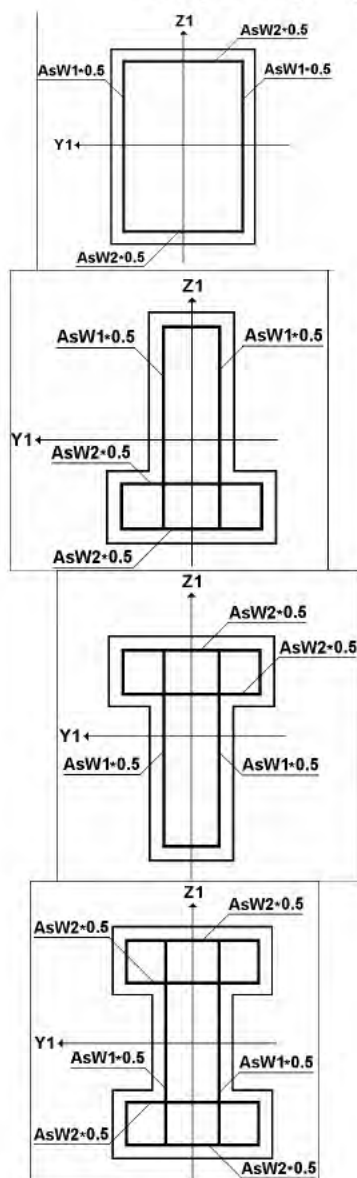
Вывод результатов по поперечной арматуре в стержнях
